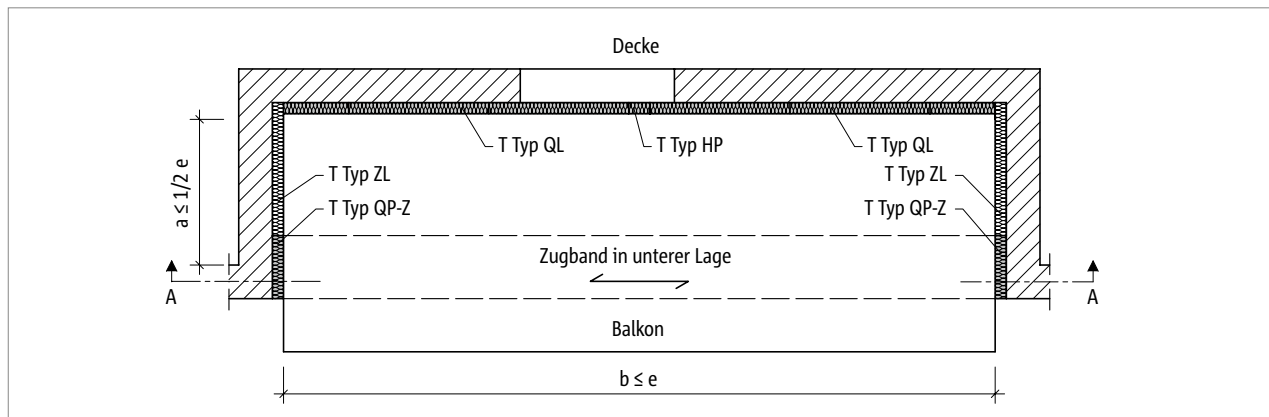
Schöck Isokorb® T Typ QP-Z, QL: Grundriss Loggia
